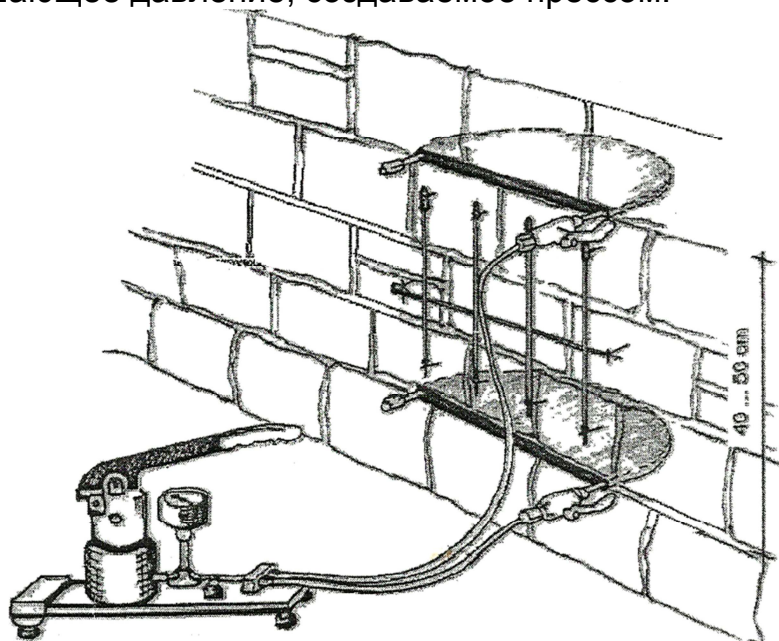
Схема испытаний каменной кладки методом «Flat-Jack-Tests»
